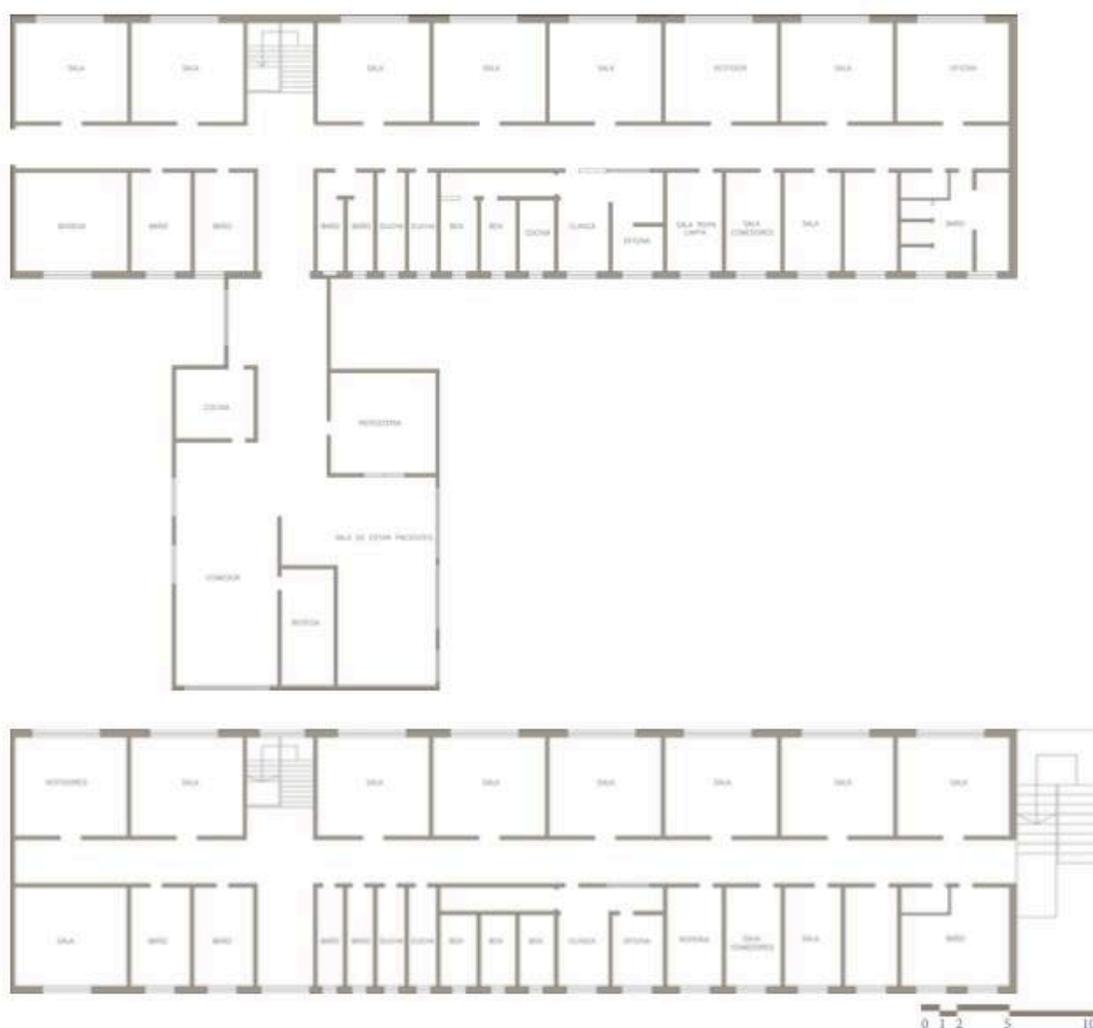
Plano pabellón Larga Estadía, 1985.
